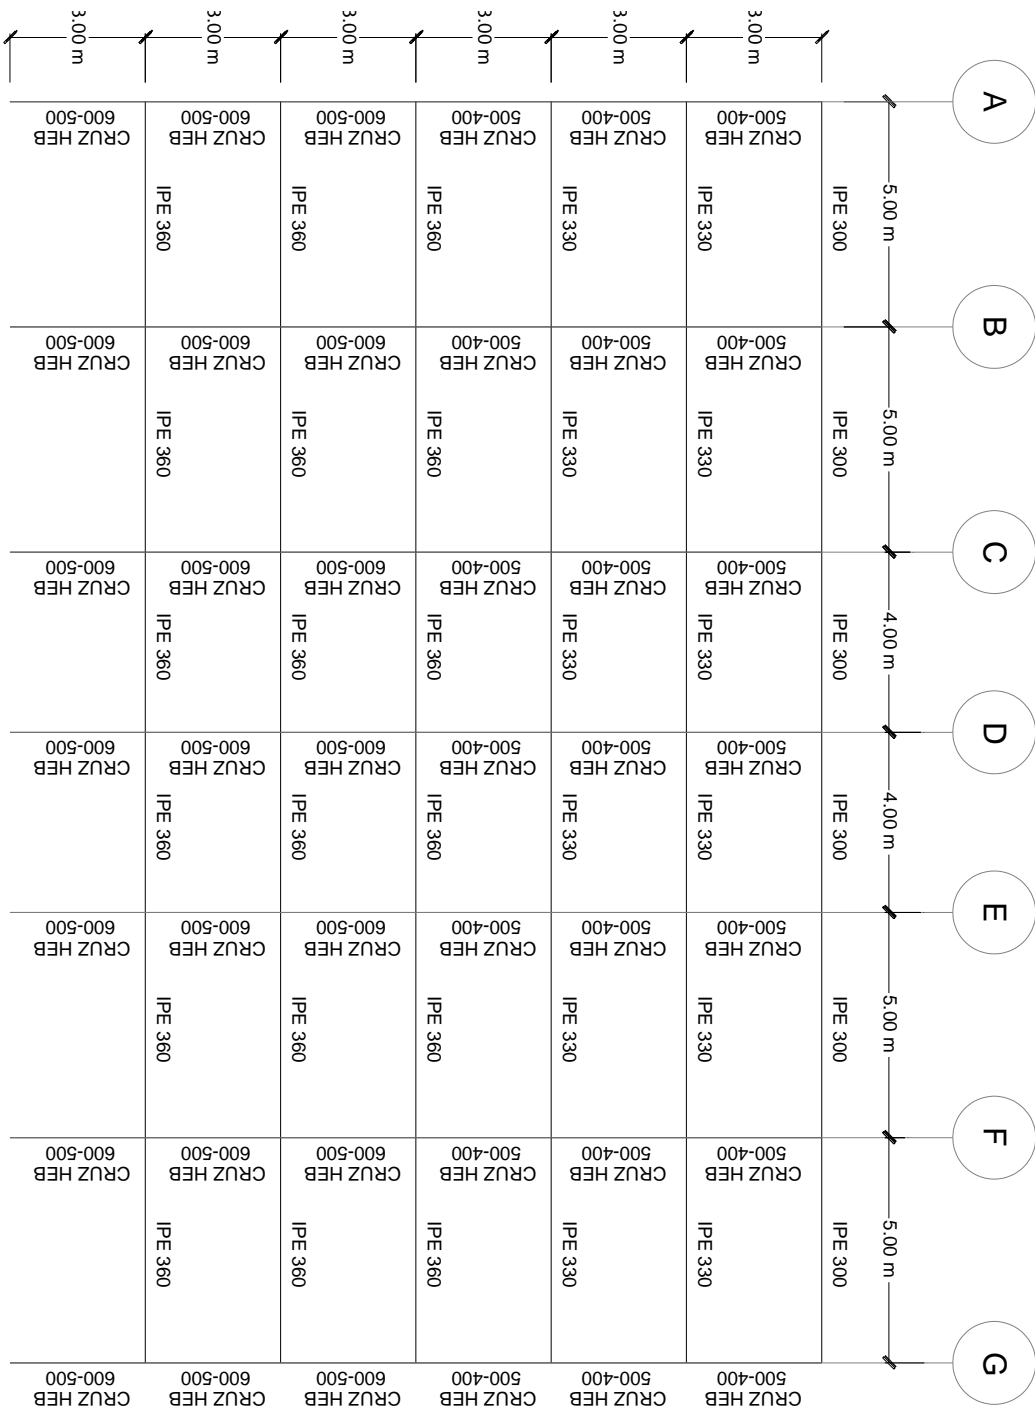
Secciones utilizadas vista en elevación ejes 2, 3, 4.
